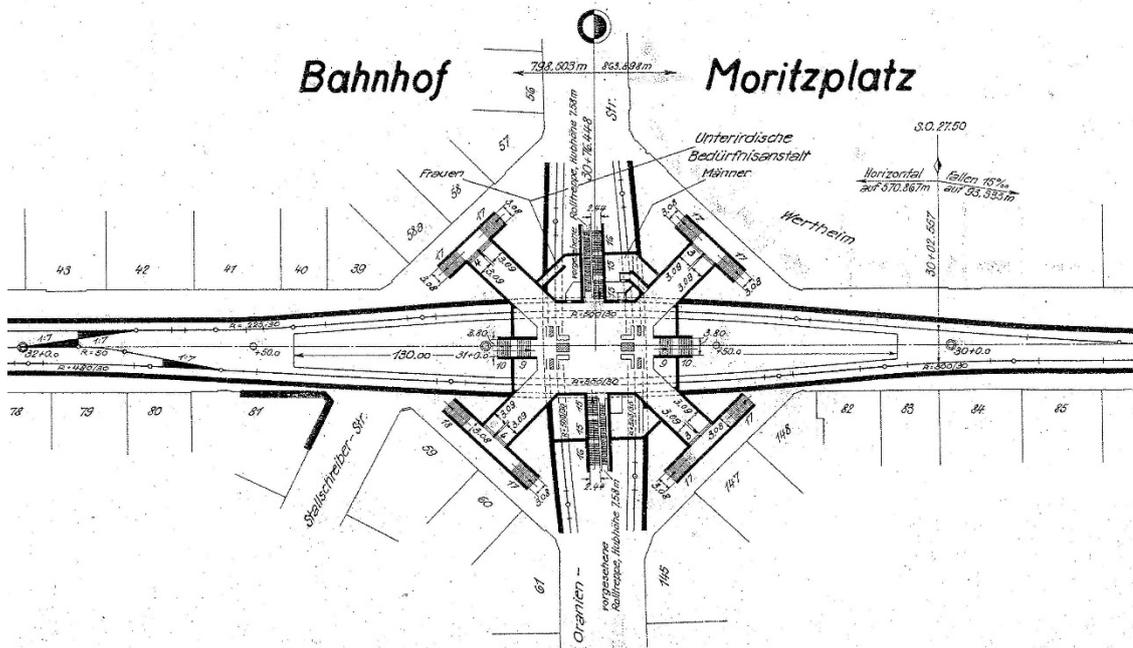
Grundriss aus der Planungszeit, Bildquelle: BVG
